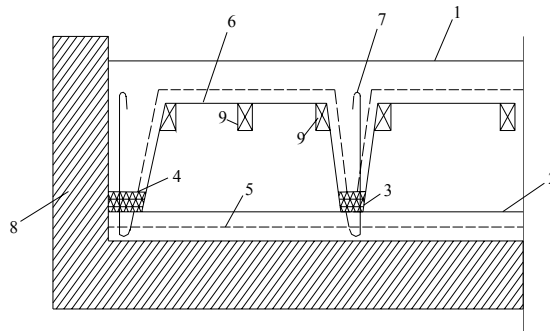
Багатопустотна панель: 1 – ребриста плита; 2 – плита стелі; 3 - звукоізоляційна прокладка; 4 – стержні ребер; 5 – арматурна сітка; 6 – сітки; 7- підвіски; 8- піддон форми; 9 – допоміжні балки
